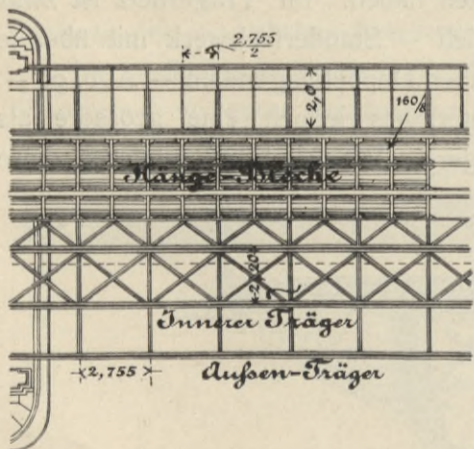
Die Grundrissanlage. 1 : 300.
